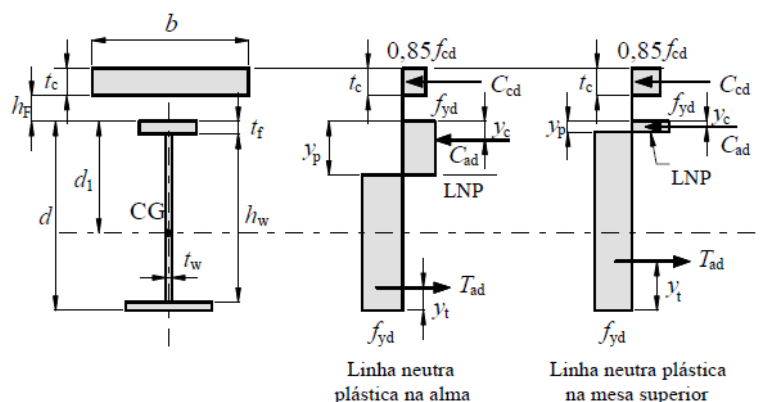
Distribuição das tensões na viga mista com linha neutra plástica na viga de aço.
